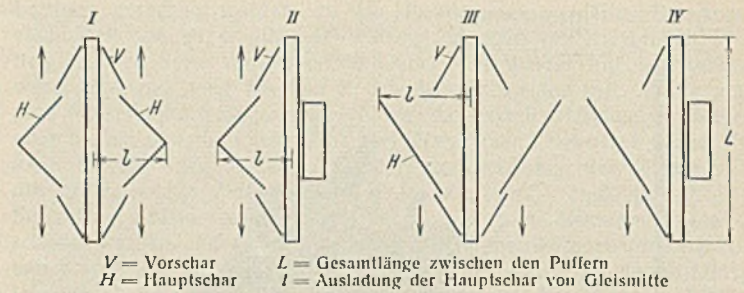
Planierpflug Bauart Beck, Type P 20 Z.
